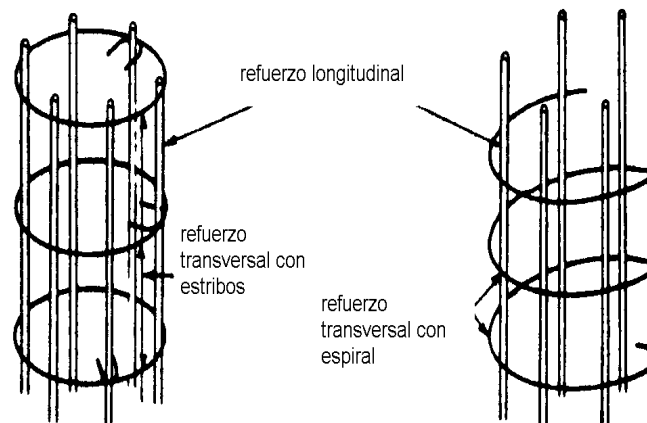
, ELEMENTOS DEL ACERO DE REFUERZO DE UNA PILA (LCPC, 1986)
